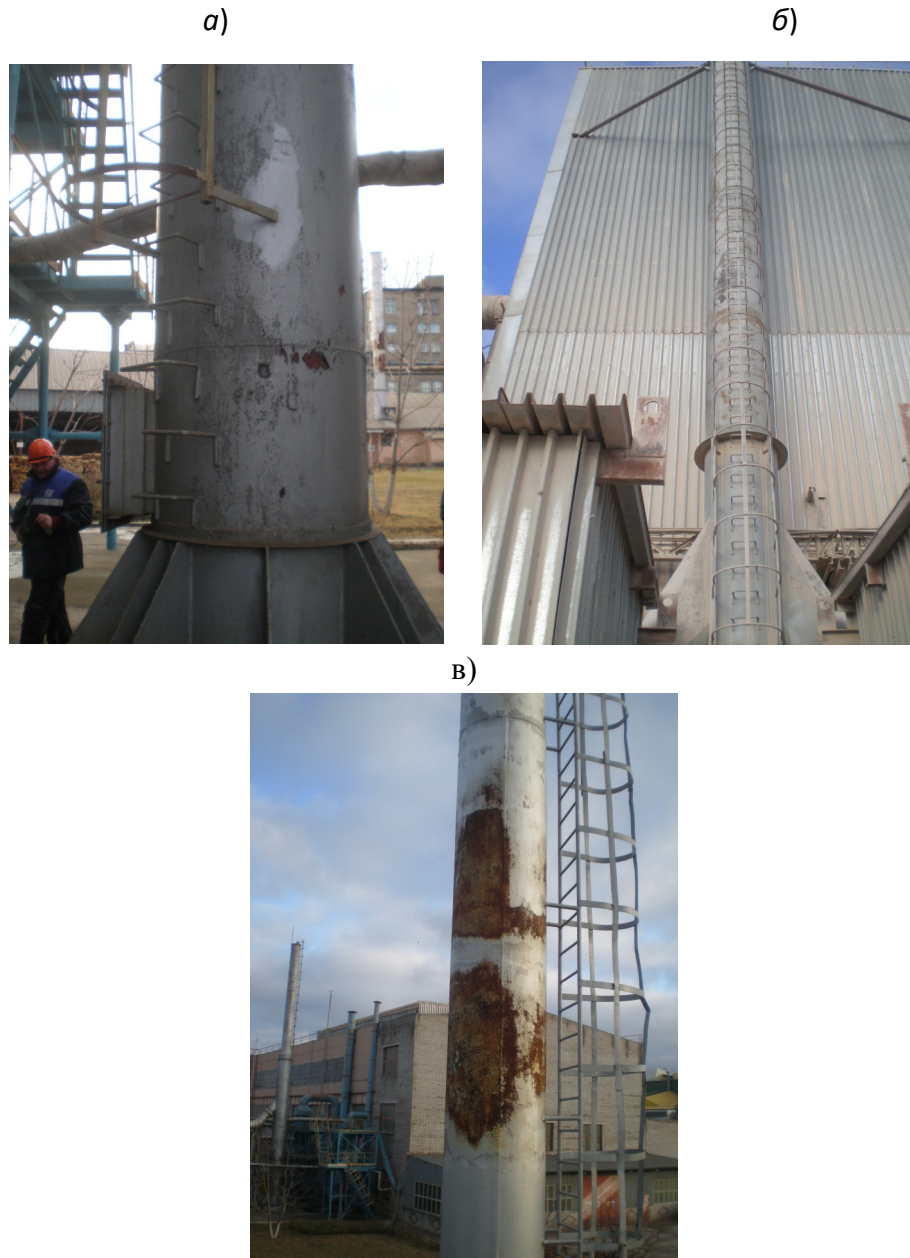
Коррозия ствола трубы и разрушение защитного лакокрасочного покрытия: дымовой трубы газоочистки печи КС-55 – (а); дымовая труба газоочистки сушильного барабана ШОС – (б), дымовая труба печи обжига огнеупоров – (в).
